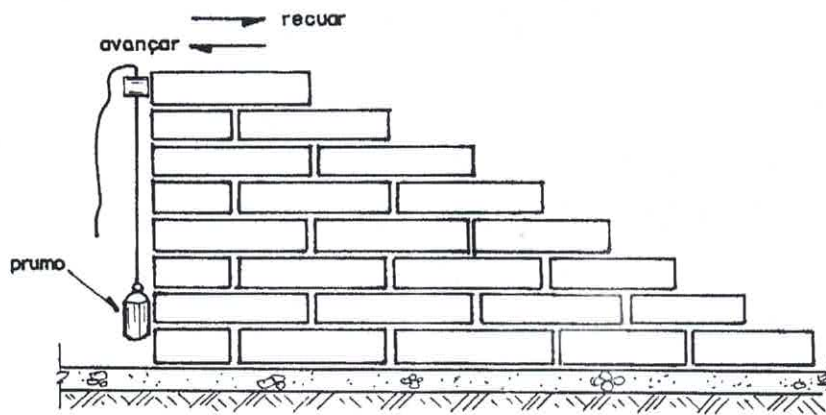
Detalhe do nivelamento da elevação da alvenaria.
